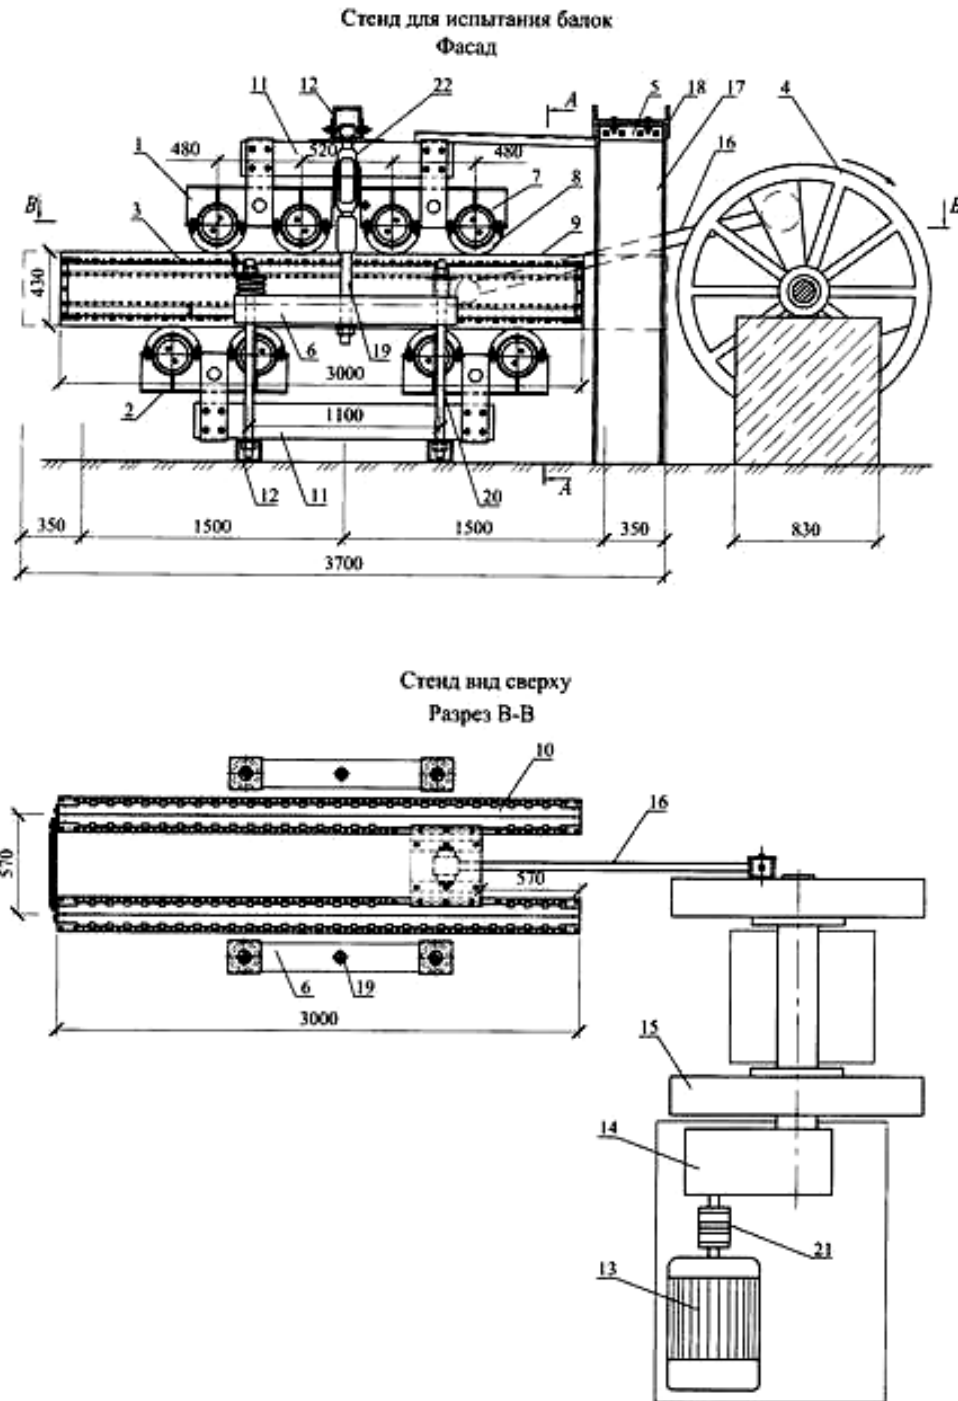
Стенд для испытания подкрановых балок на выносливость
